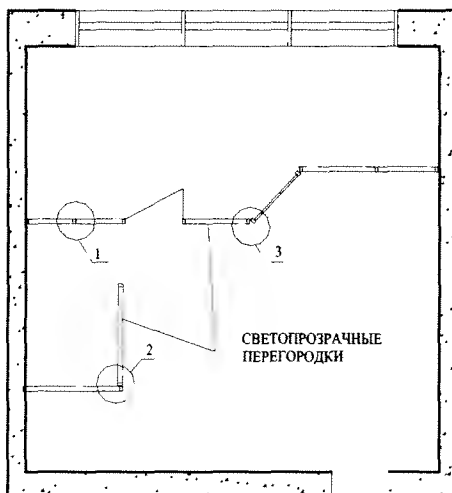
Пример установки светопрозрачных перегородок в помещении. План
